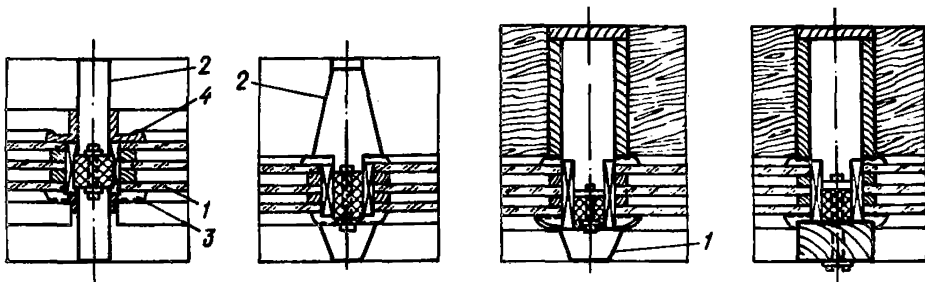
Узлы витрин с двухкамерными стеклопакетами из стальных, деревянных, деревоалюминиевых и алюминиевых профилей
